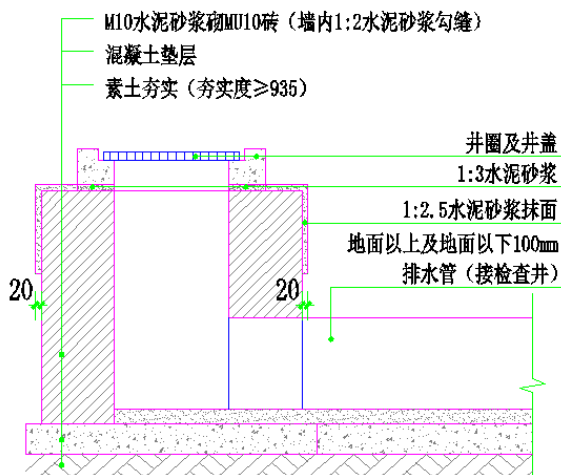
平算式雨水口 2-2 剖面示意图
